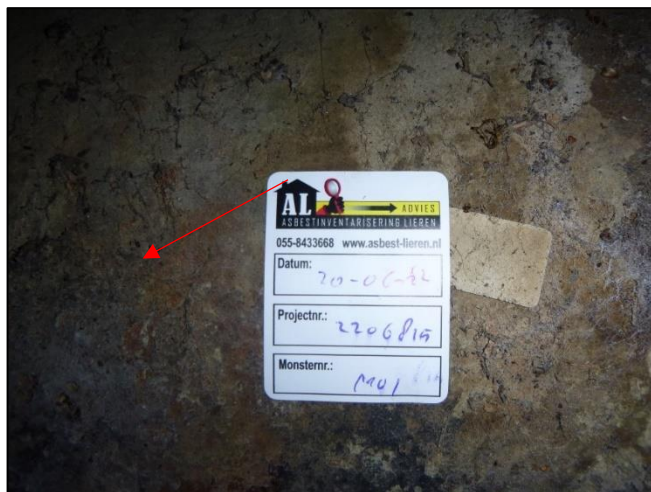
Ter hoogte van waterrad: Buis (Bron 1) (Asbesthoudend)
